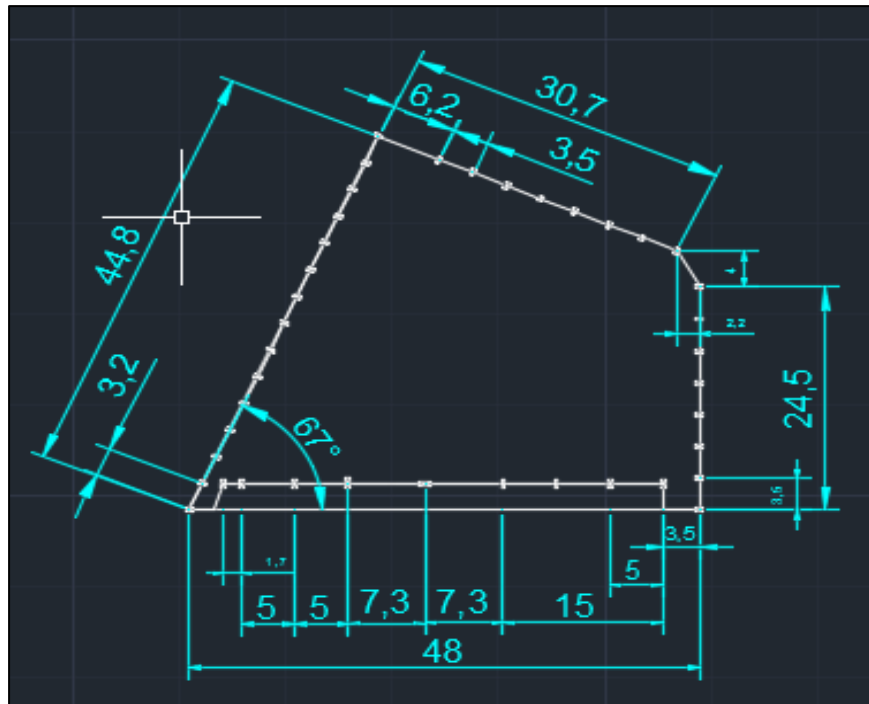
Dimensiones de la plaza Von Siemens y distancia entre pilares de la fachada en metros.
